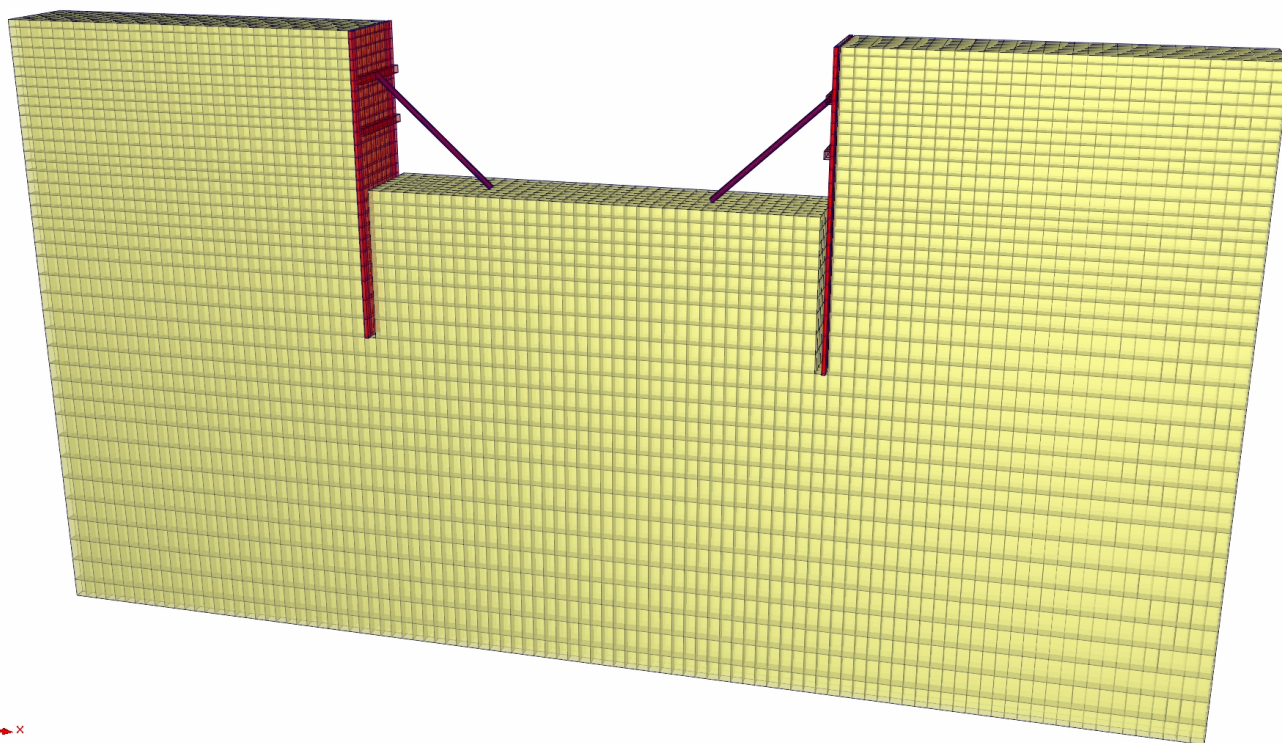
Окончательная схема подкосной системы крепления стен глубокого котлована
